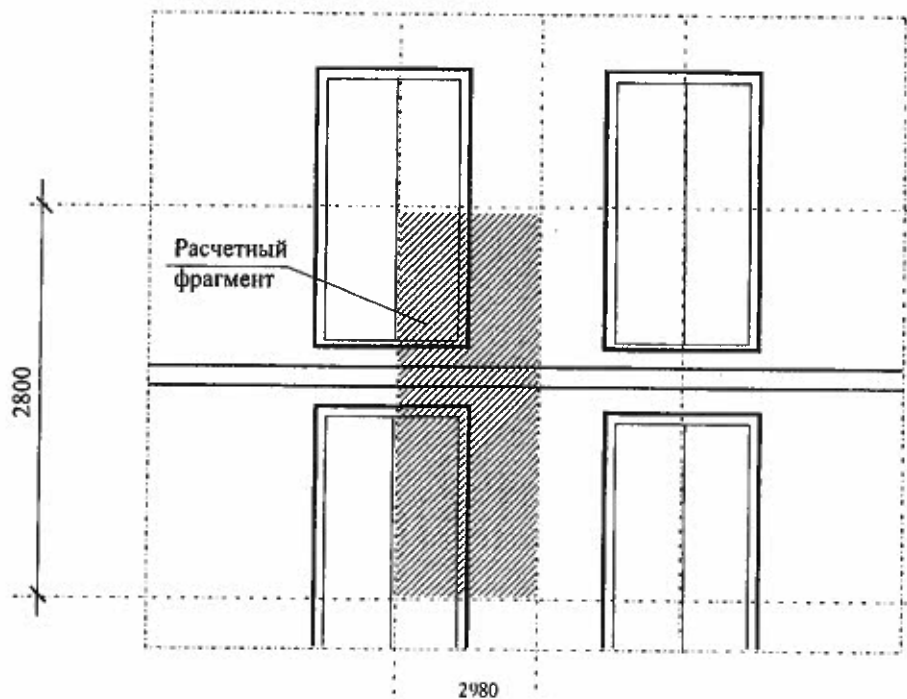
Расчетная схема фрагмента наружной стены здания для определения приведенного сопротивления теплопередаче участка с балконными дверьми (вид со стороны помещения)
